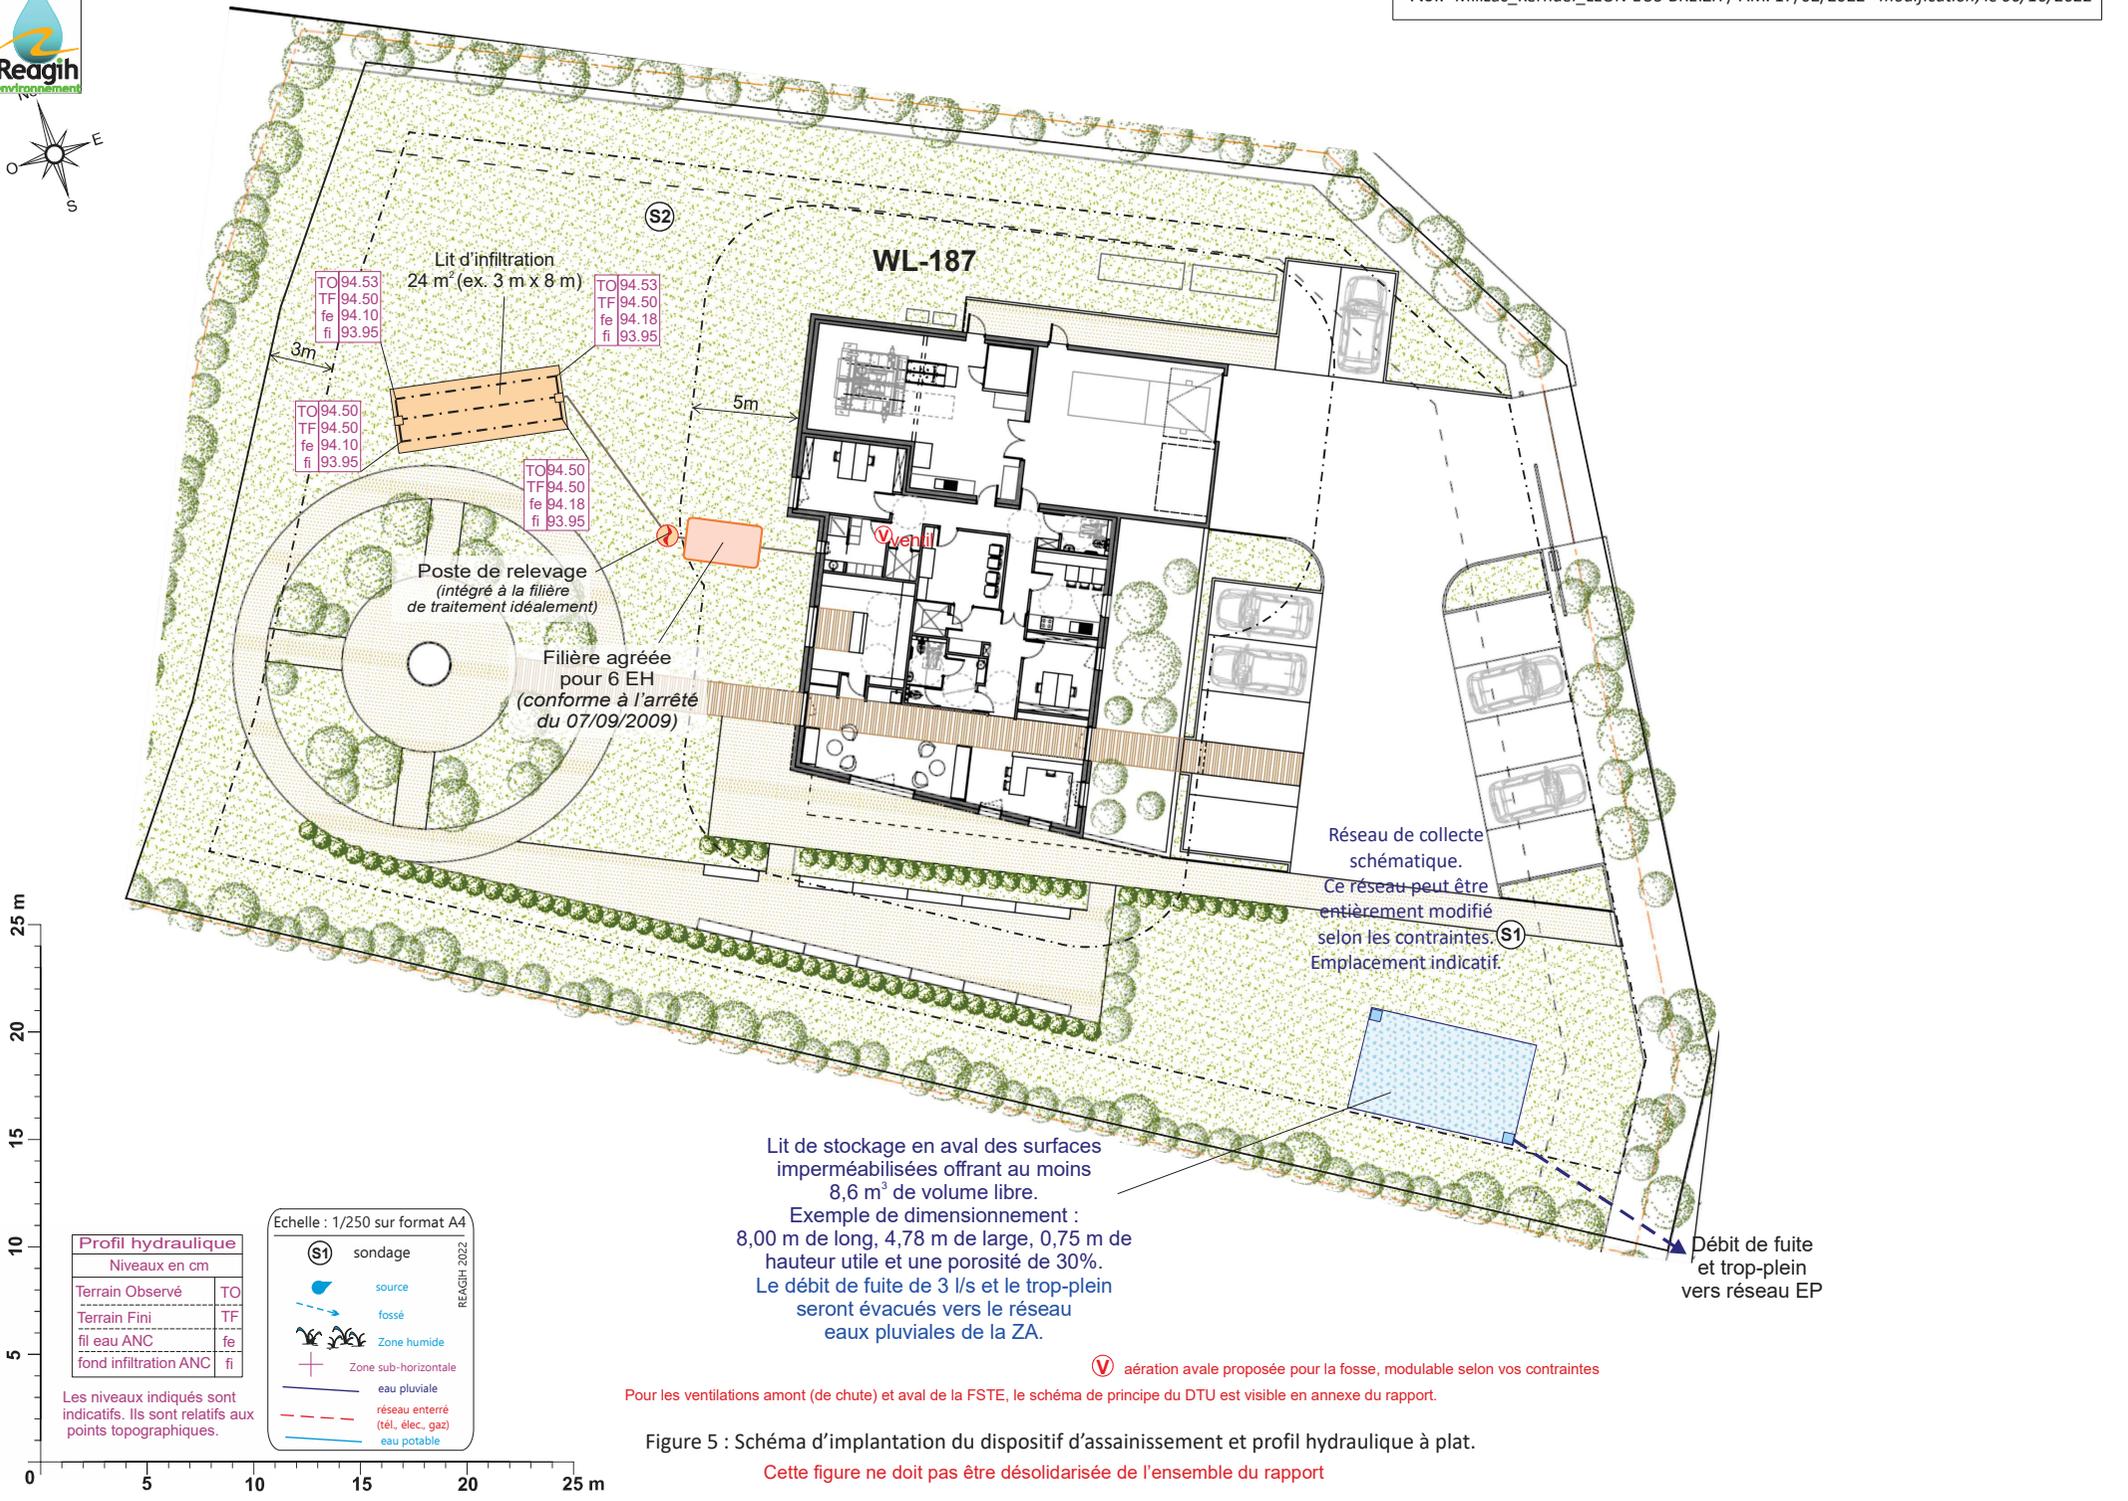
Schéma d'implantation du dispositif d'assainissement et profil hydraulique à plat.
